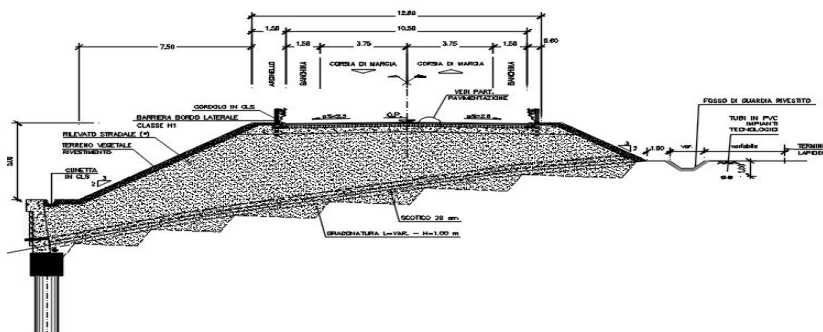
Sezione tipo in rilevato asse principale con intervento di gradonatura
